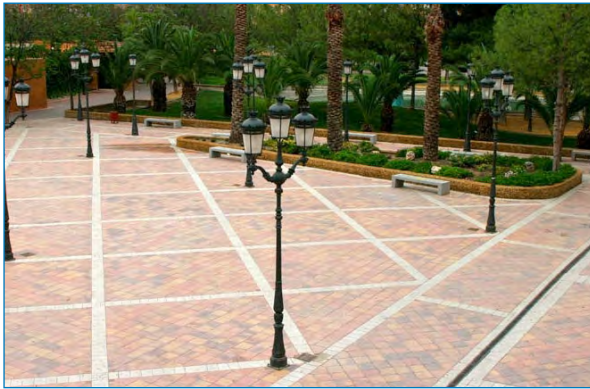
Losa prefabricada de hormigón./ www.prefabricadosroda.com.
